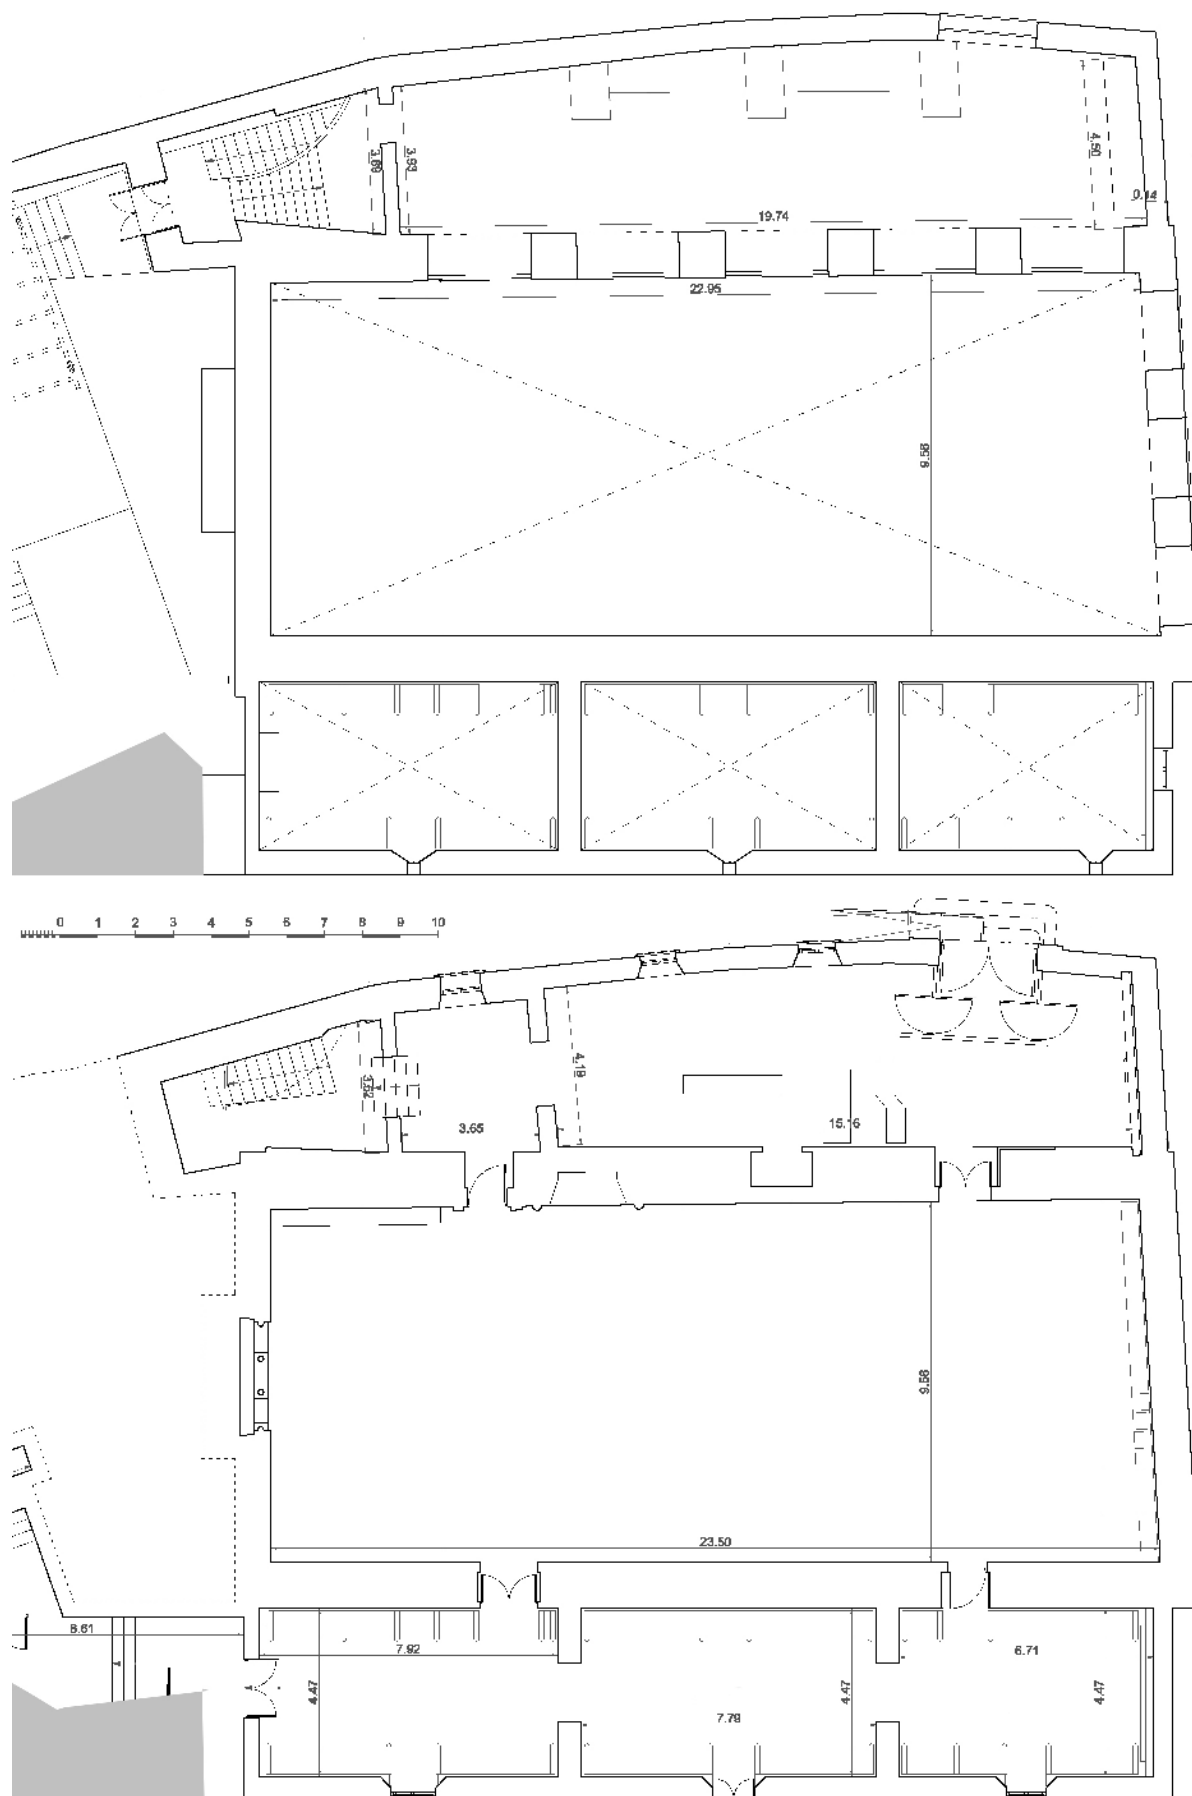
Planta actual del edificio: planta primera (superior) y planta baja (inferior).
